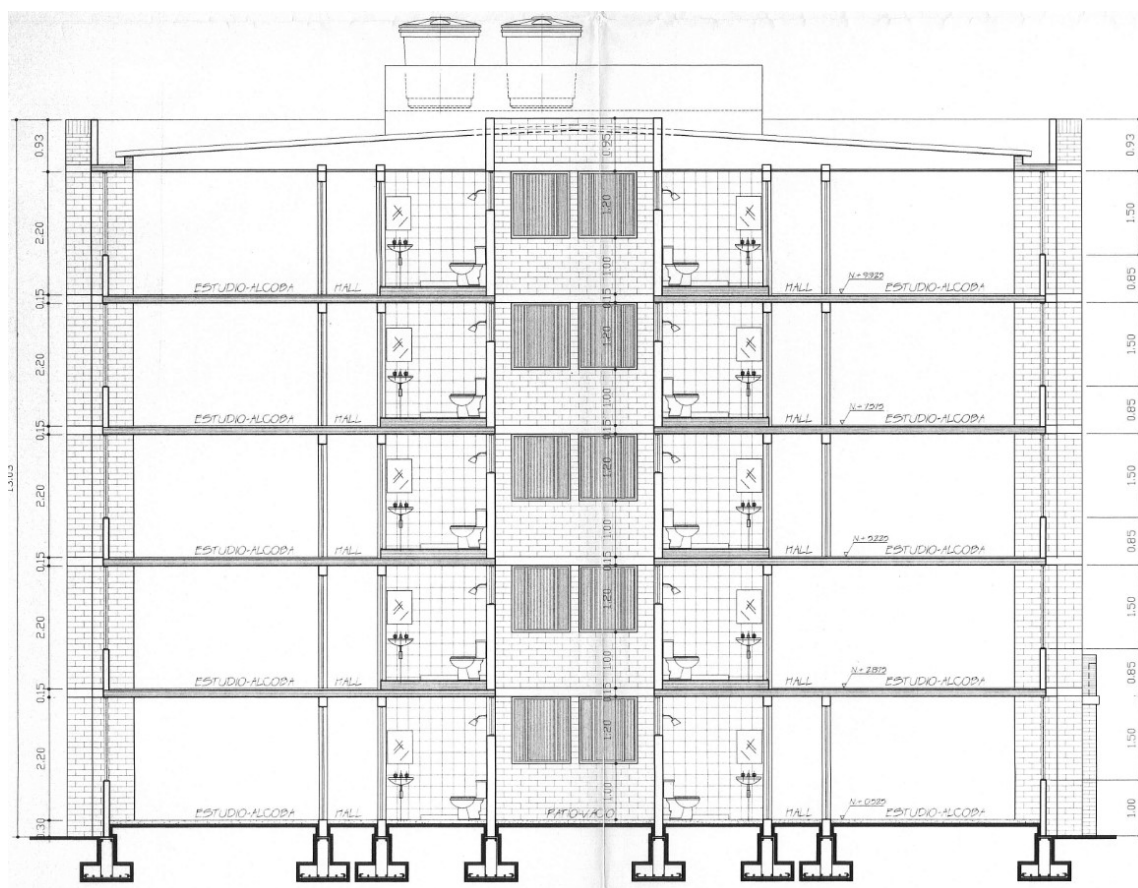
Distribución arquitectónica en alzado (Fuente. Plano arquitectónico 07).
